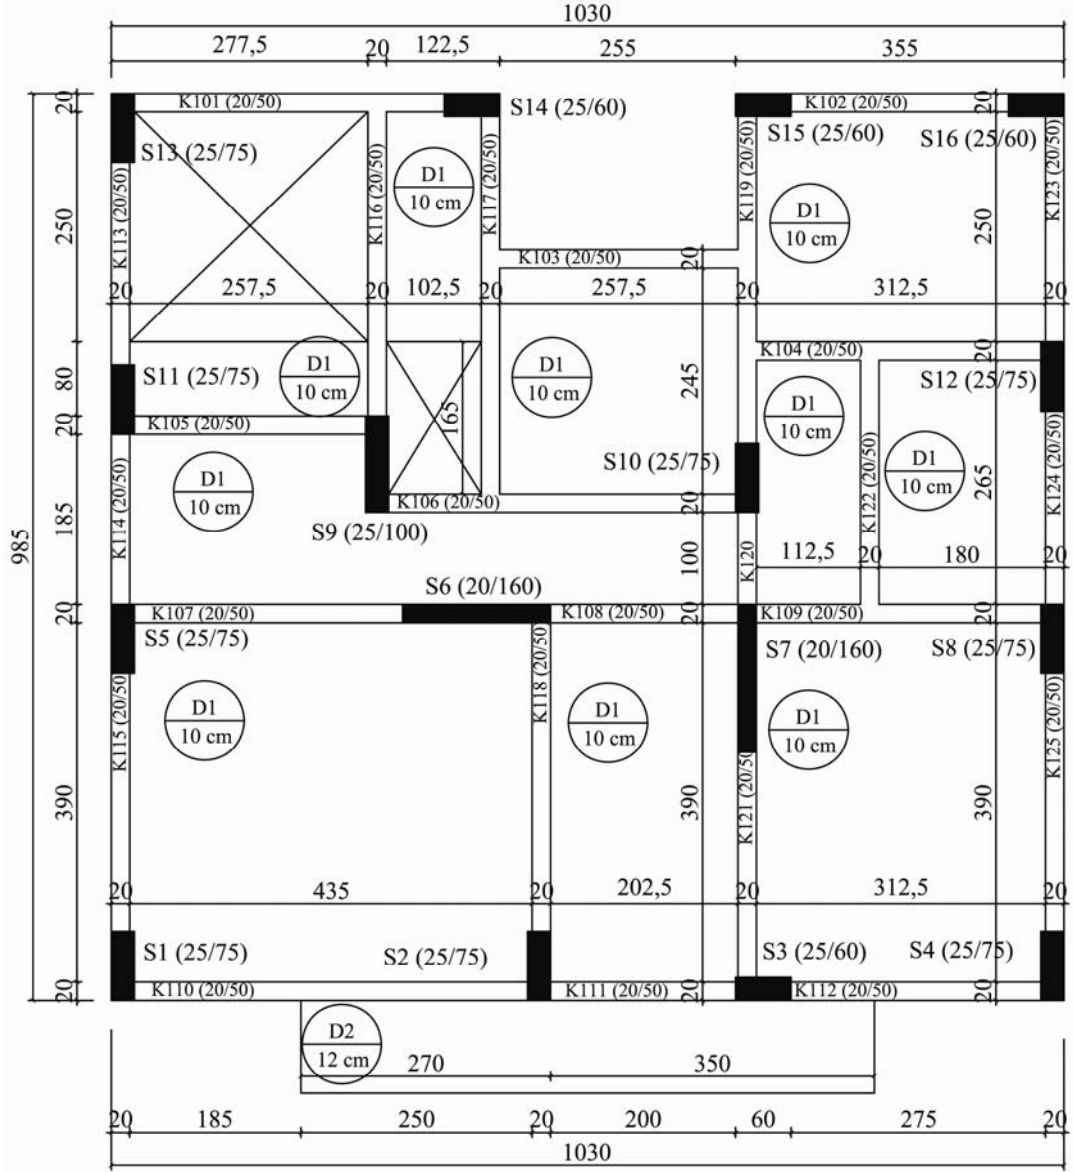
B6\_4'ün kat kalıp planı
